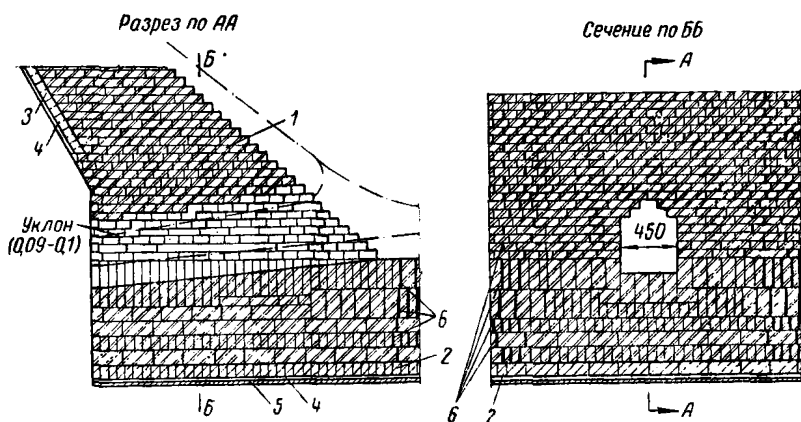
Сталевыпускное отверстие с перекрытием постепенным напуском рядов
